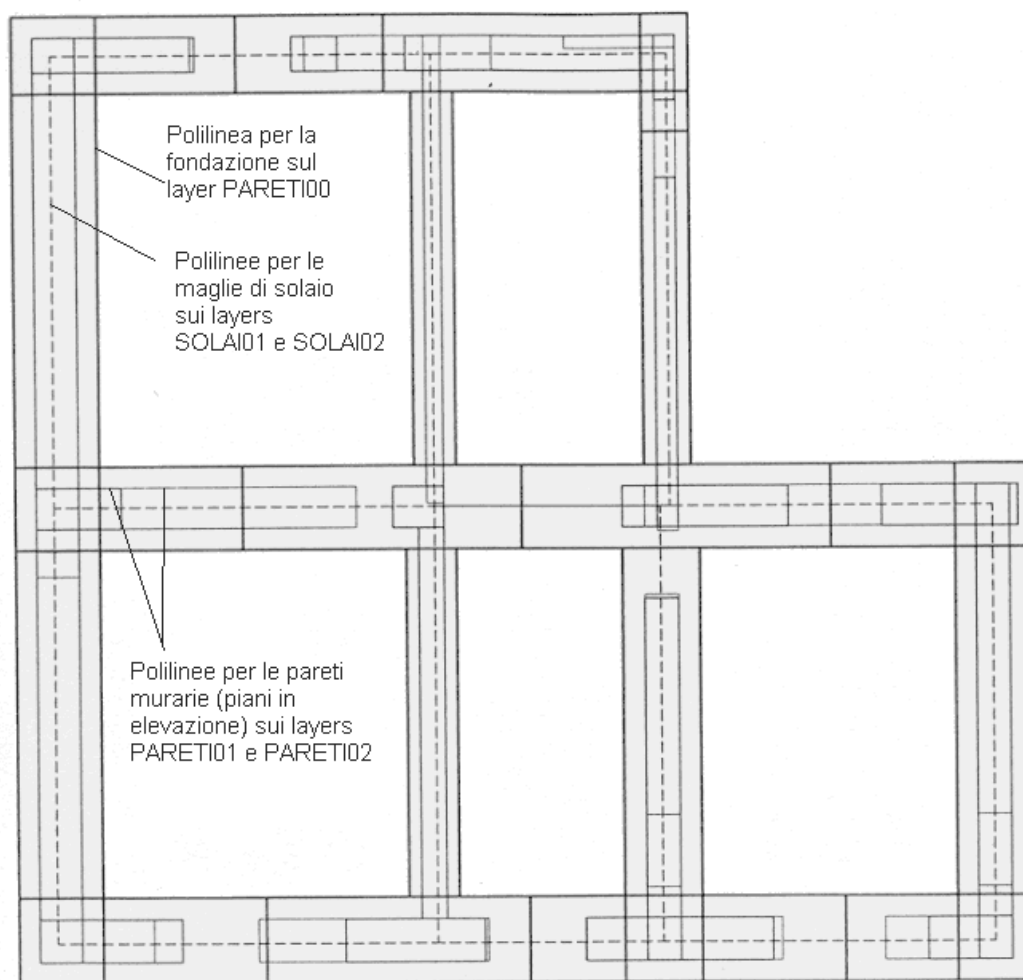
Pianta Piano Terreno Stato Attuale.
